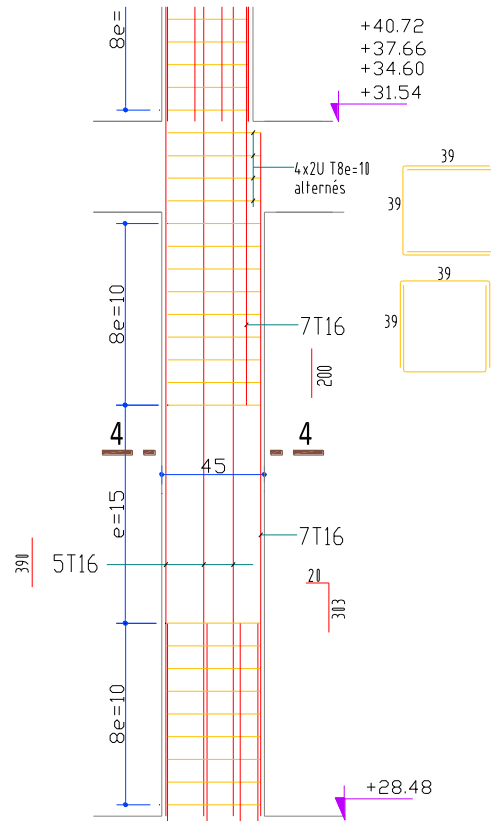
Coupe verticale de ferrailage des poteaux $45 \times 45 \text{ cm}^2$.
